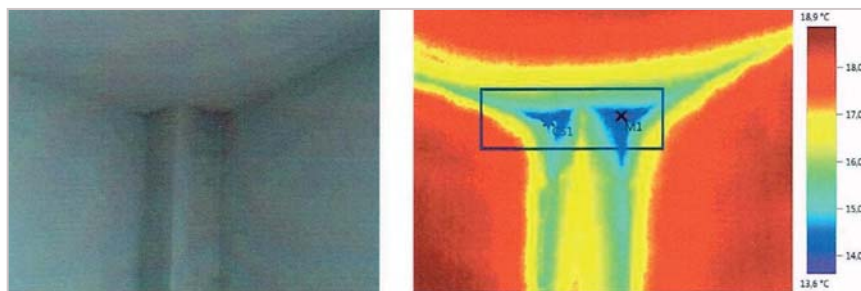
Теплотехнический дефект в узле сопряжения наружной стены с железобетонной колонной
